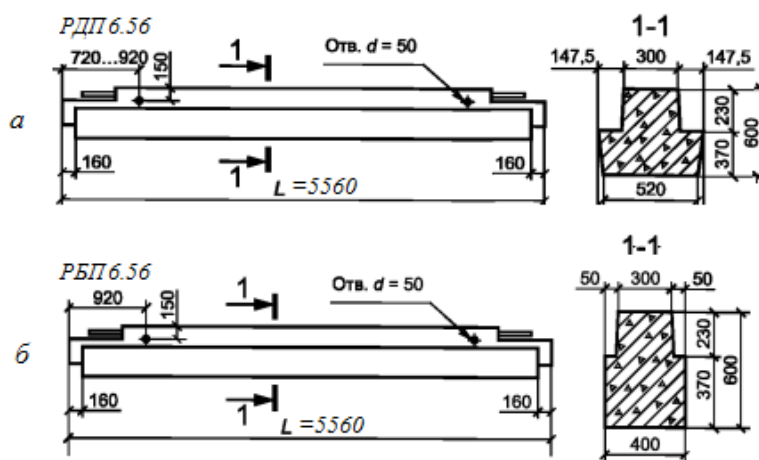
Типовые сборные железобетонные ригели по ГОСТ 18980-2015: а – ригель двухполочный для опирания многопустотных плит марки РДП 6.56 (цифры 56 и 6 – длина ригеля и высота его поперечного сечения в дм); б – ригель бесполочный для примыкания многопустотных плит марки РБП 6.56
